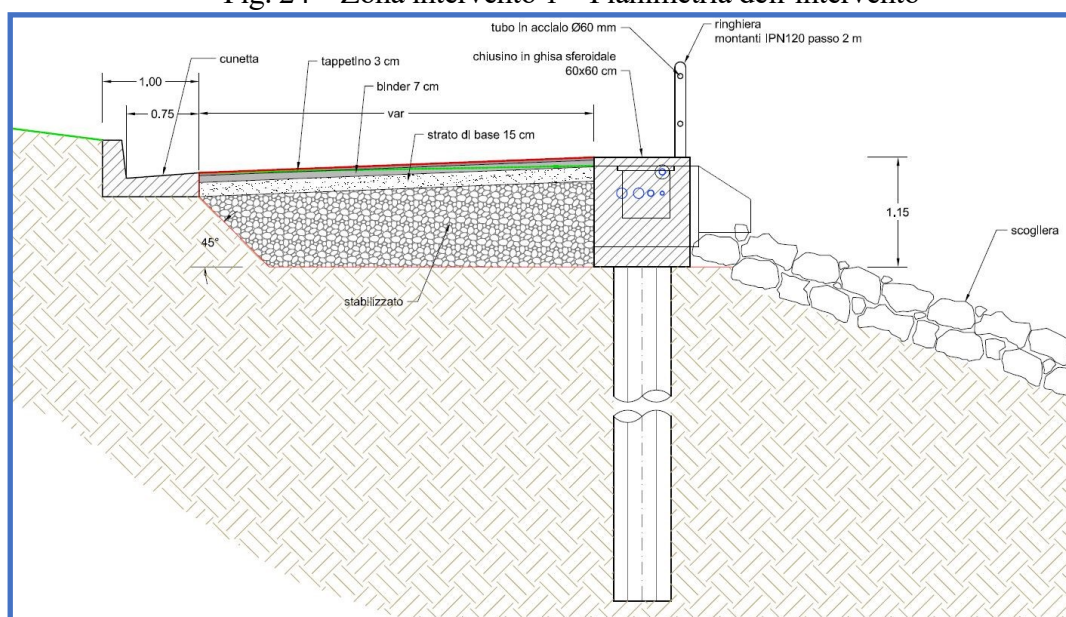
Zona intervento 1 – Sezione tipo dell'intervento
